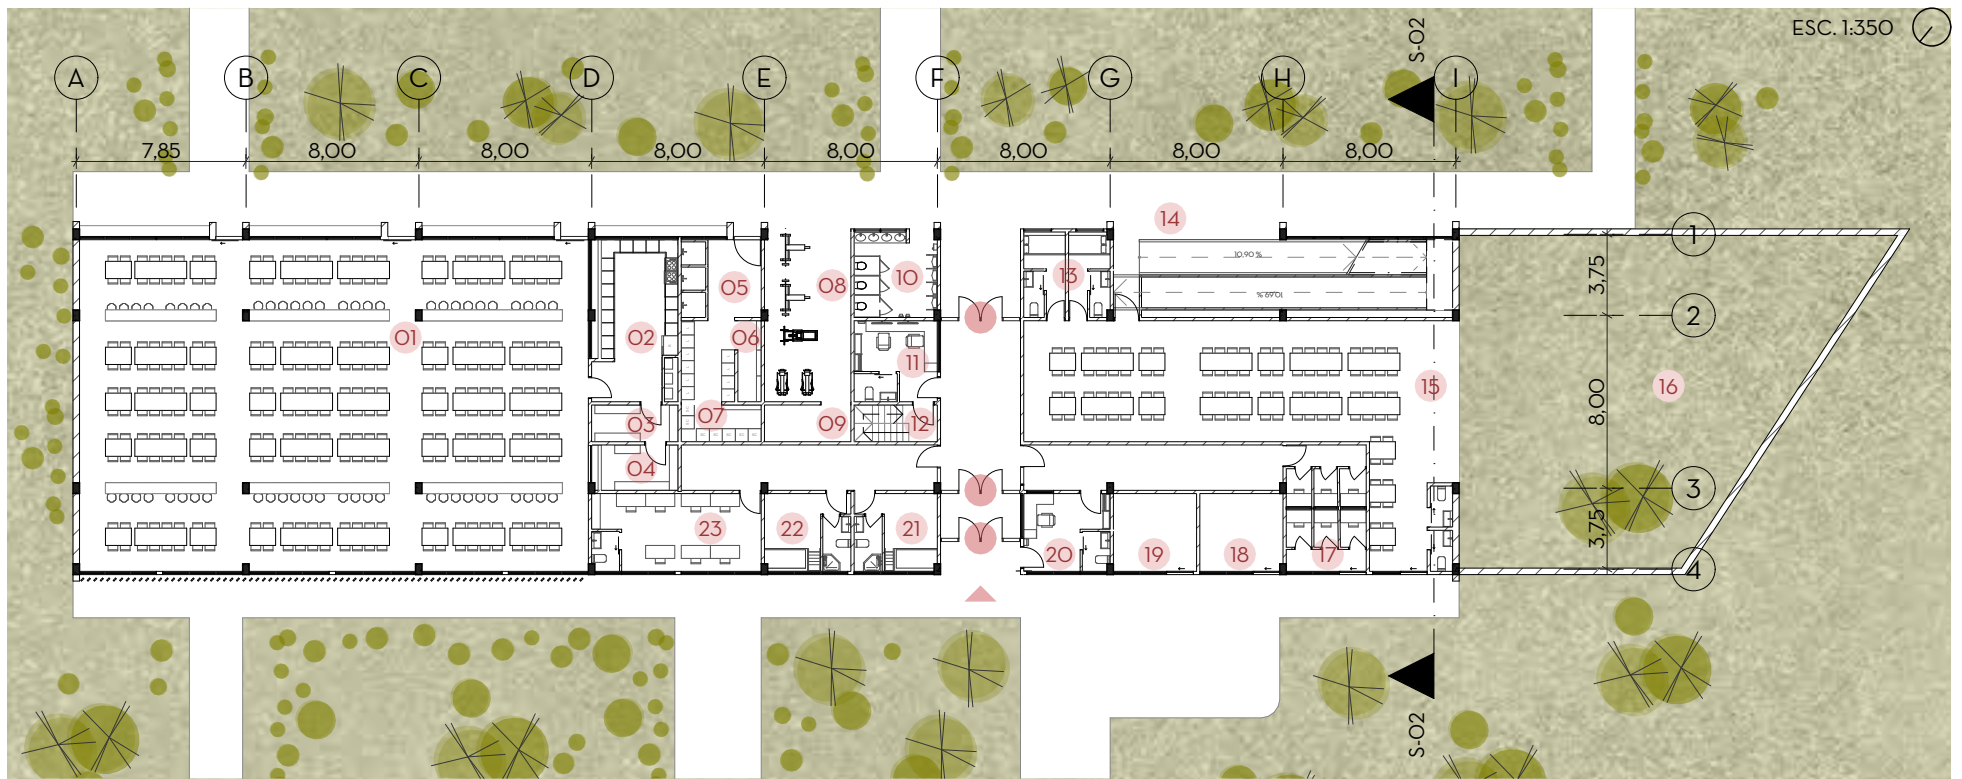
Planta baja edificio de actividades. Fuente: Autoría propia
